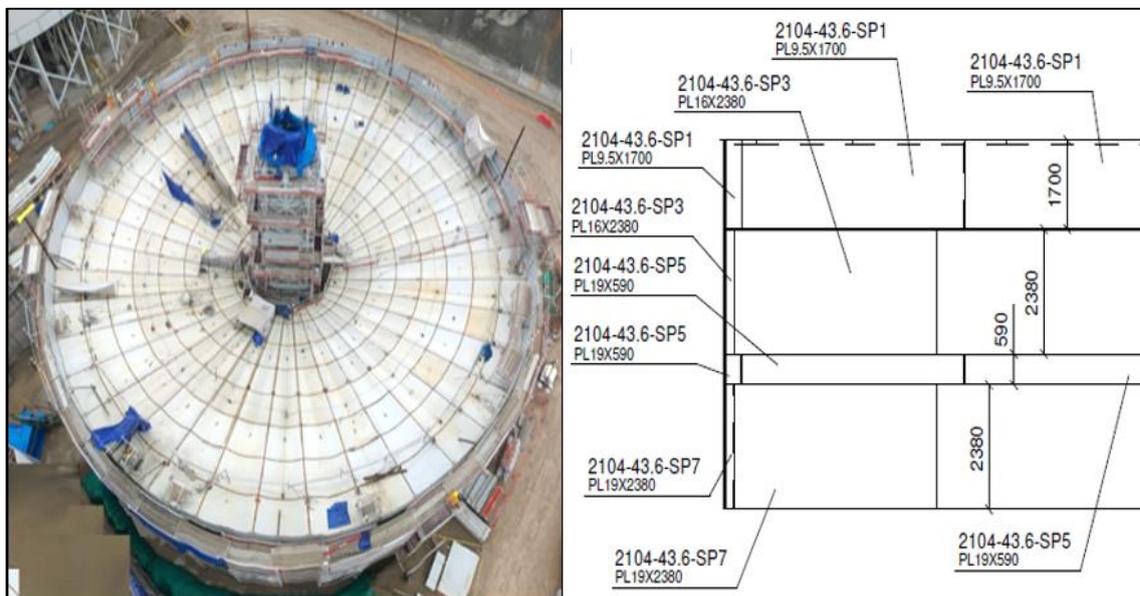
Montaje de Planchas Laterales (Izquierda), detalle de plano (Derecha)
